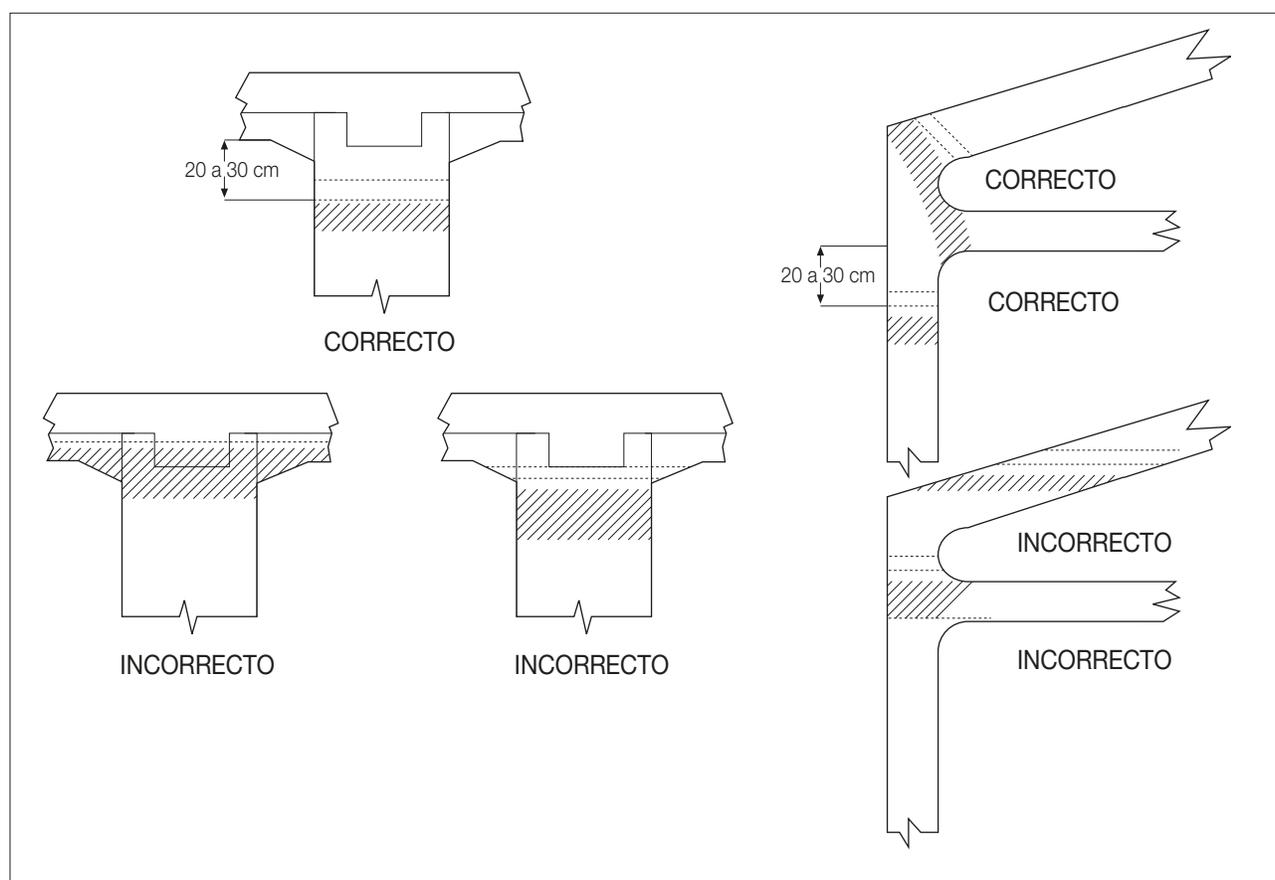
Ubicación de las Juntas de Hormigonado (NCh170.Of85)
